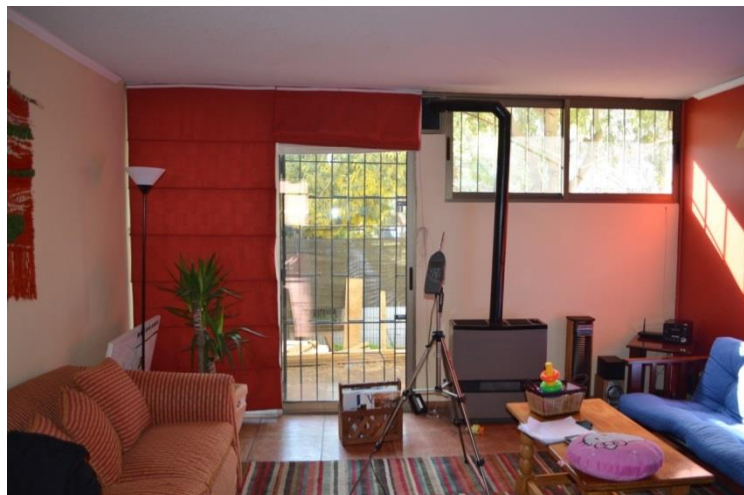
Vista interior de la fachada utilizada para el ensayo.
